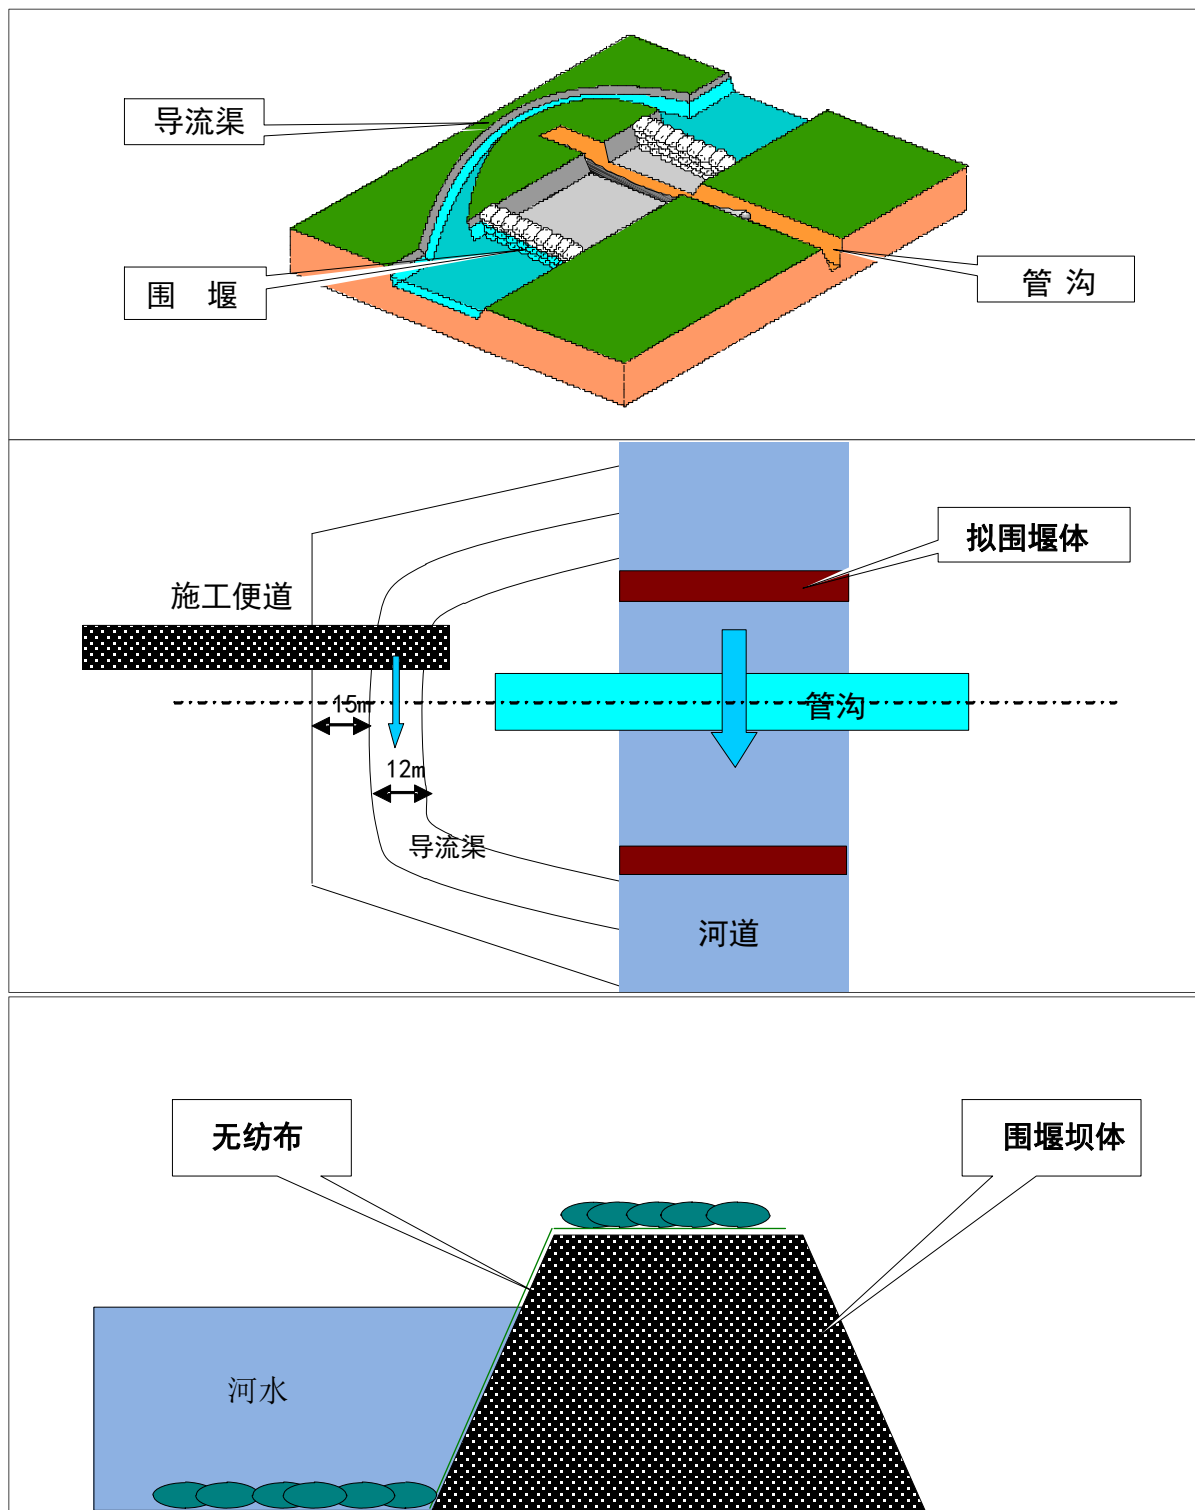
围堰导流开挖管沟法施工断面示意图
